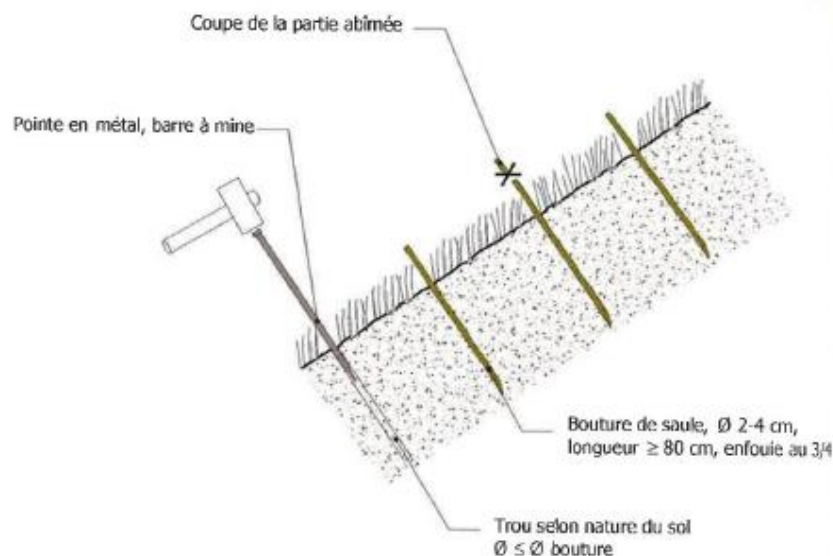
Schéma type d'implantation de bouture de saule (ADAM et al., 2008)
